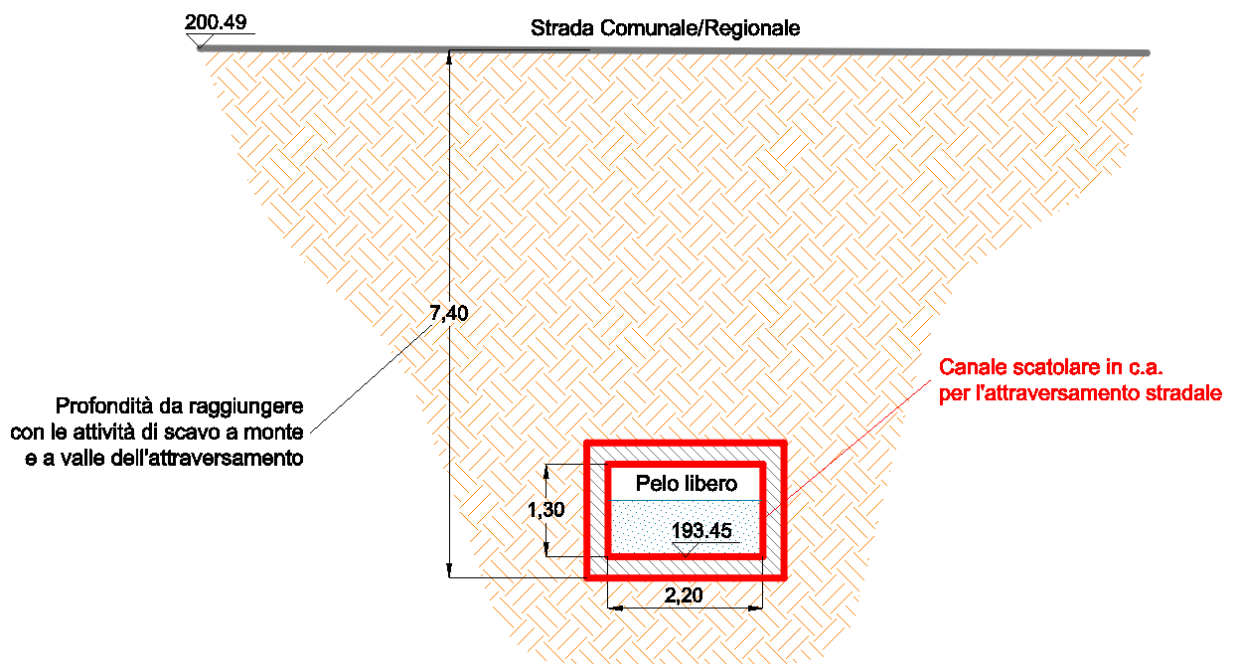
Sezione tipo dell'attraversamento delle infrastrutture stradali.
